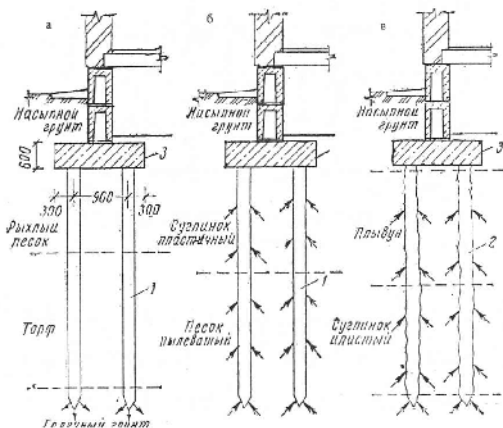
Свайные фундаменты: а - сваи - стойки; б, в - сваи висячие; 1 - забивные сваи; 2 - набивные сваи; 3 - железобетонный ростверк
